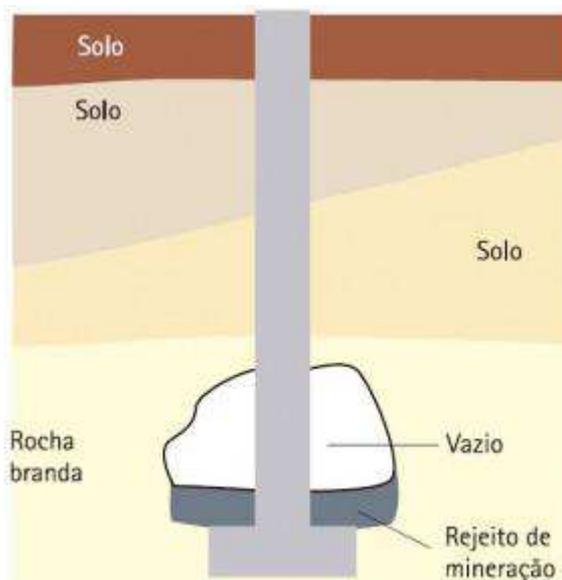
Fundação do tipo tubulão assente no nível da base de galeria na região de mineração em Santa Catarina. (Retirado do livro Patologia das Fundações 2ª edição)
